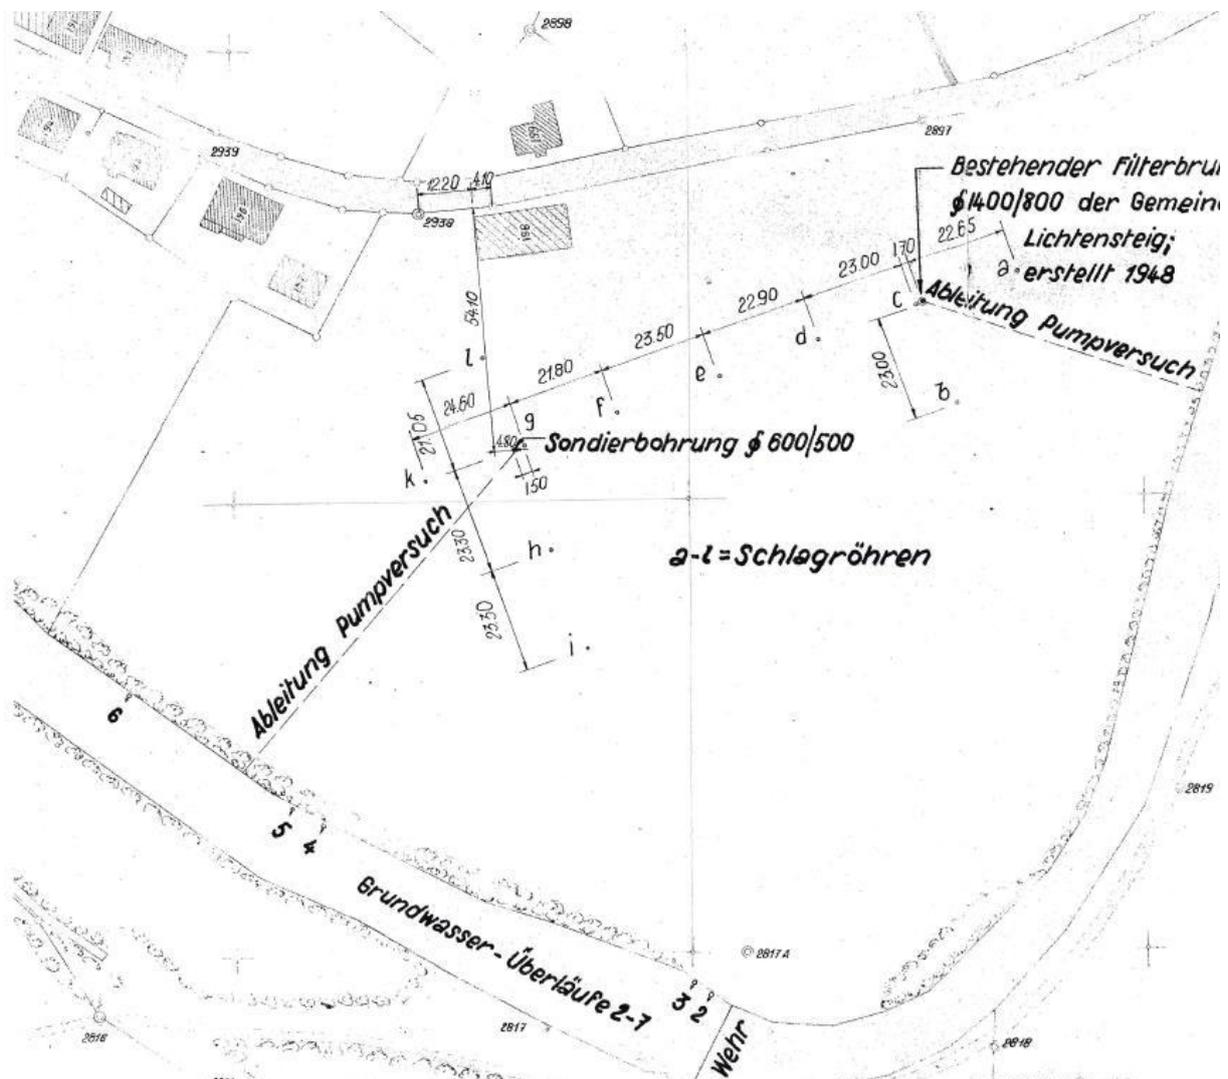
Undatierter Planauszug mit eingetragenen Grundwasser-Überläufen
